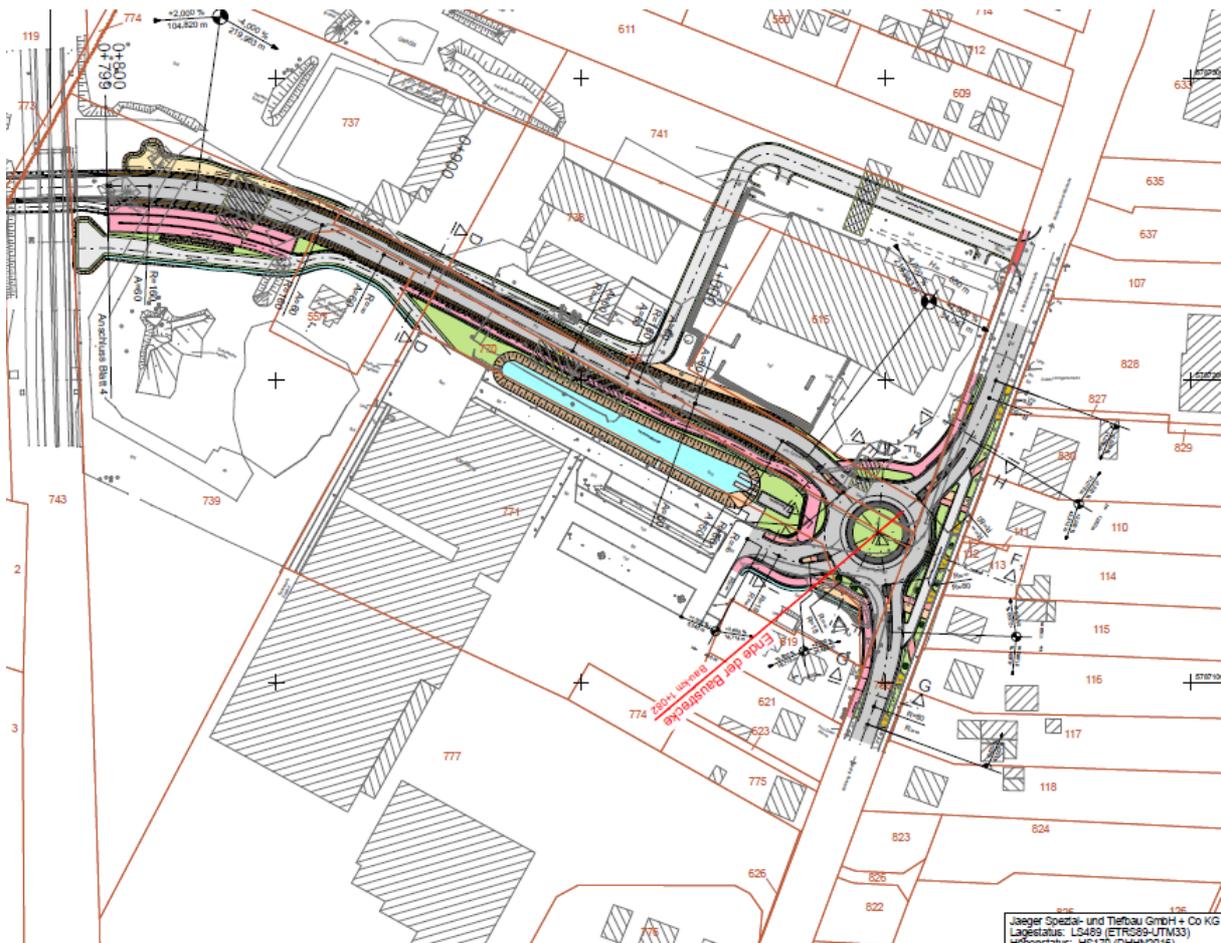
Straßenbau, Ausschnitt Übersichtslageplan Ost, Blatt 02, ASB Berlin-Dresden, Umbau Bf. Zossen – Neubau B246
